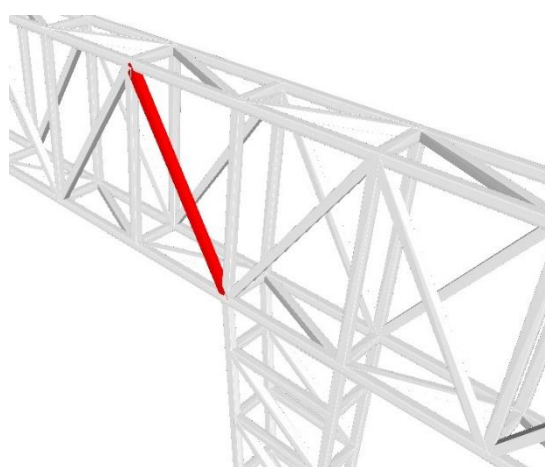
| Barra diagonal de pórtico intermedio
